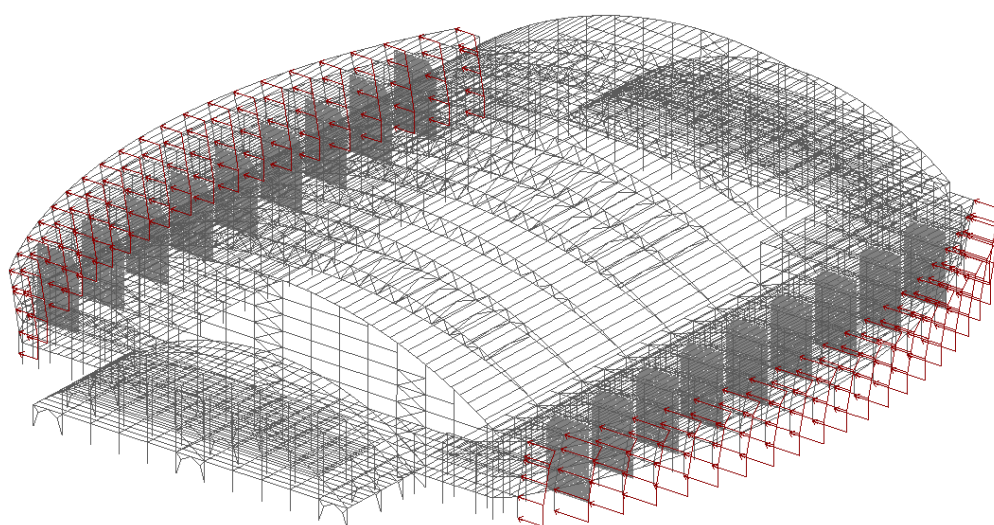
Схема приложения ветровой нагрузки на колонны
